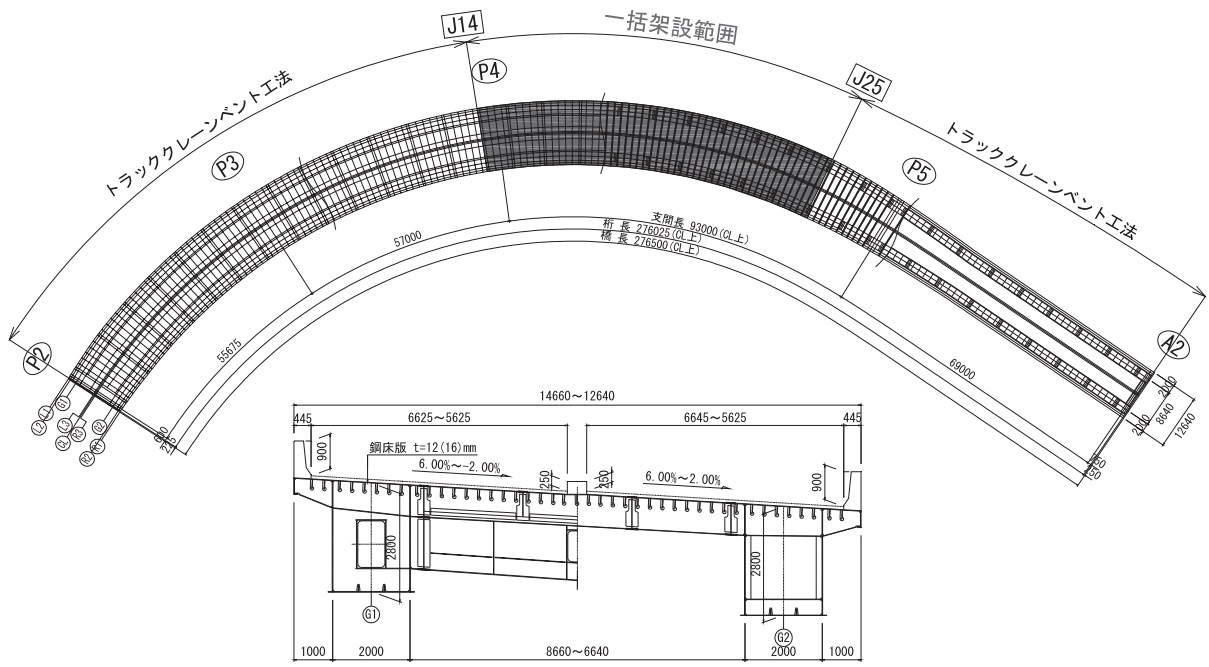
阿賀ICランプ橋一般図(平面図・断面図)
